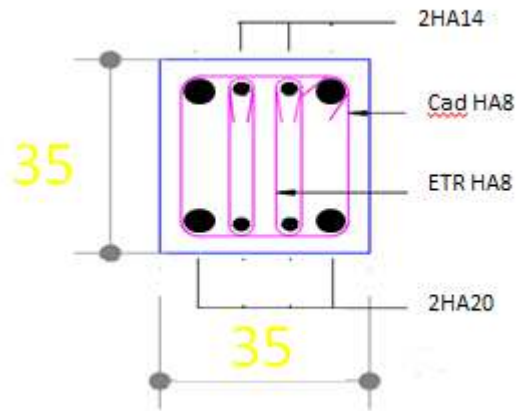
Schéma de ferrailage des poteaux de 3ème modèle.
